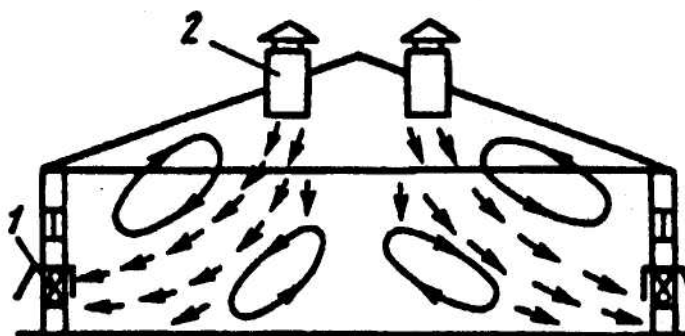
Вытяжная вентиляция с настенными вентиляторами: 1 - настенные вентиляторы; 2 - приточные шахты.
